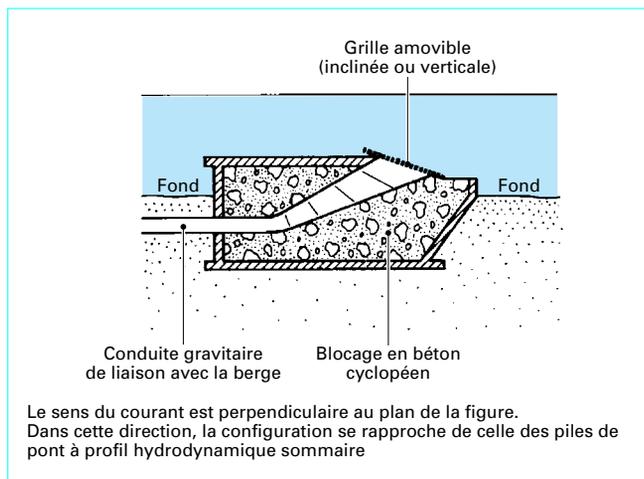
Embouchure d'une prise d'eau en pleine eau
